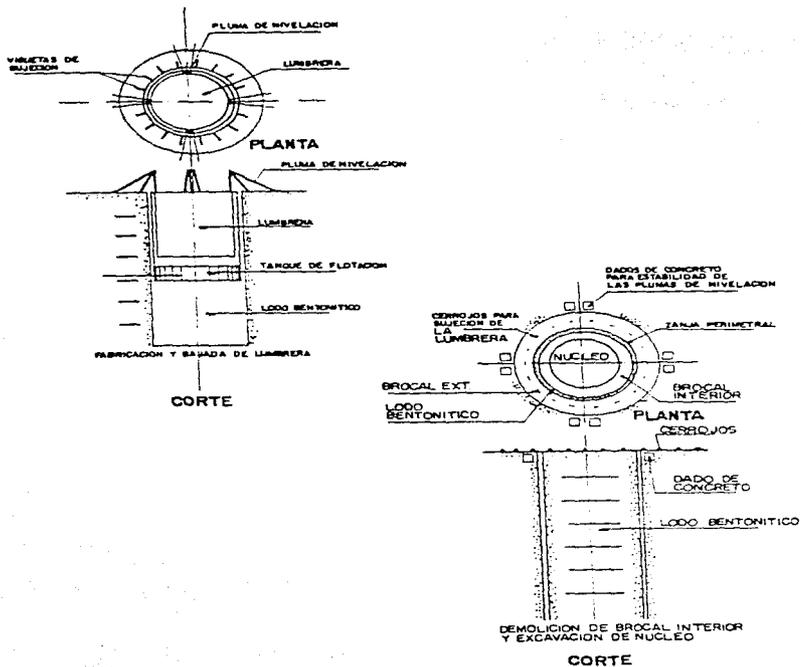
DETALLE CONSTRUCTIVO EN LA INMERSION DEL TANQUE
